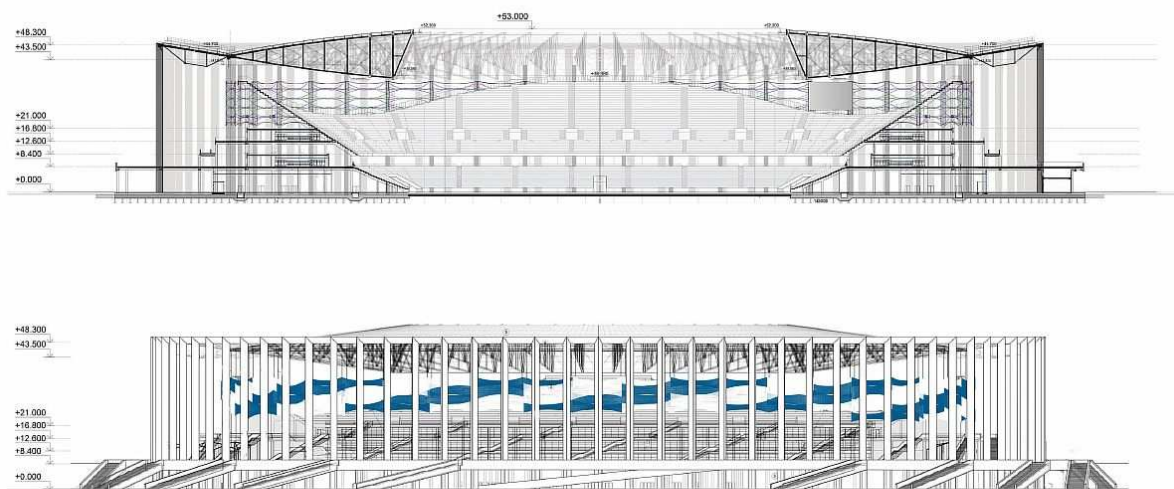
Планировка стадиона «Нижний Новгород»: его разрез и фасад
